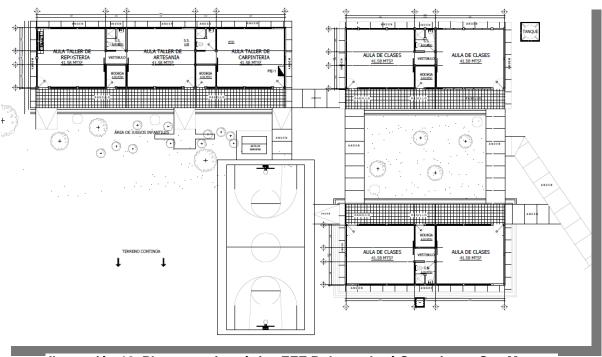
Planta arquitectónica EEE Roberto José Sequeira en San Marcos
